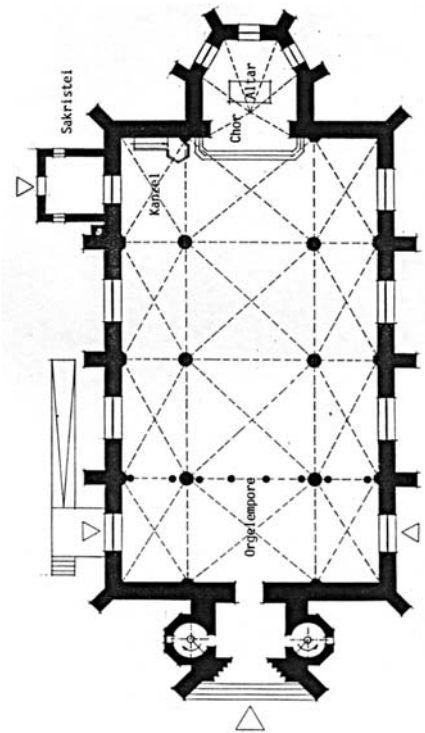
Grundriss, Bauaufnahme Juni 1989
